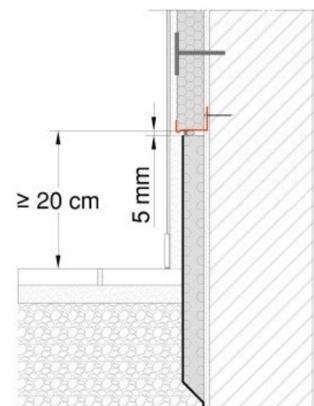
Detalle de continuidad del sistema de aislamiento de pared enterrada
